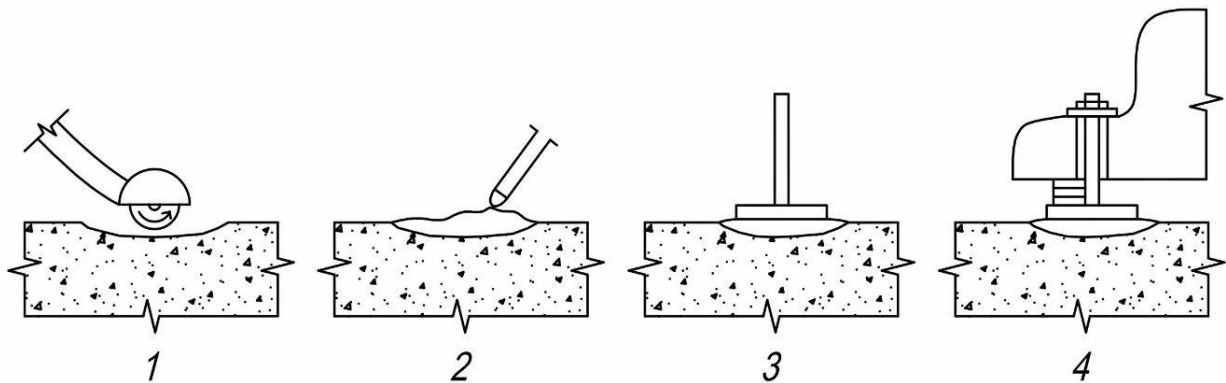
Схема приклеювання вузлів кріплення до монтажу виробничого обладнання: 1 – зачищення бетонної поверхні; 2 – нанесення клею; 3 – приклеювання кріпильного вузла; 4 – установка і вивіряння обладнання на інвентарних підкладках-фіксаторах
